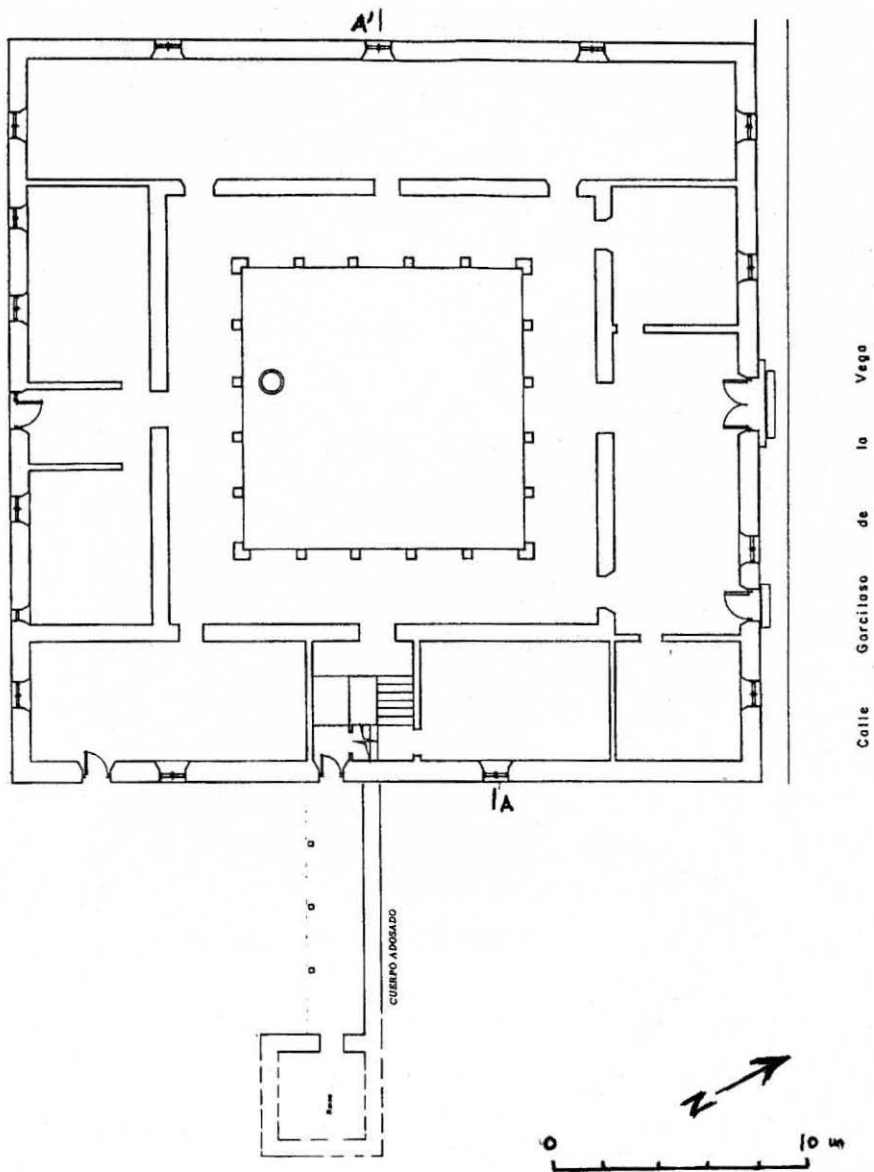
Plano de planta a escala 1:200 (según Moraleda Bravo).
